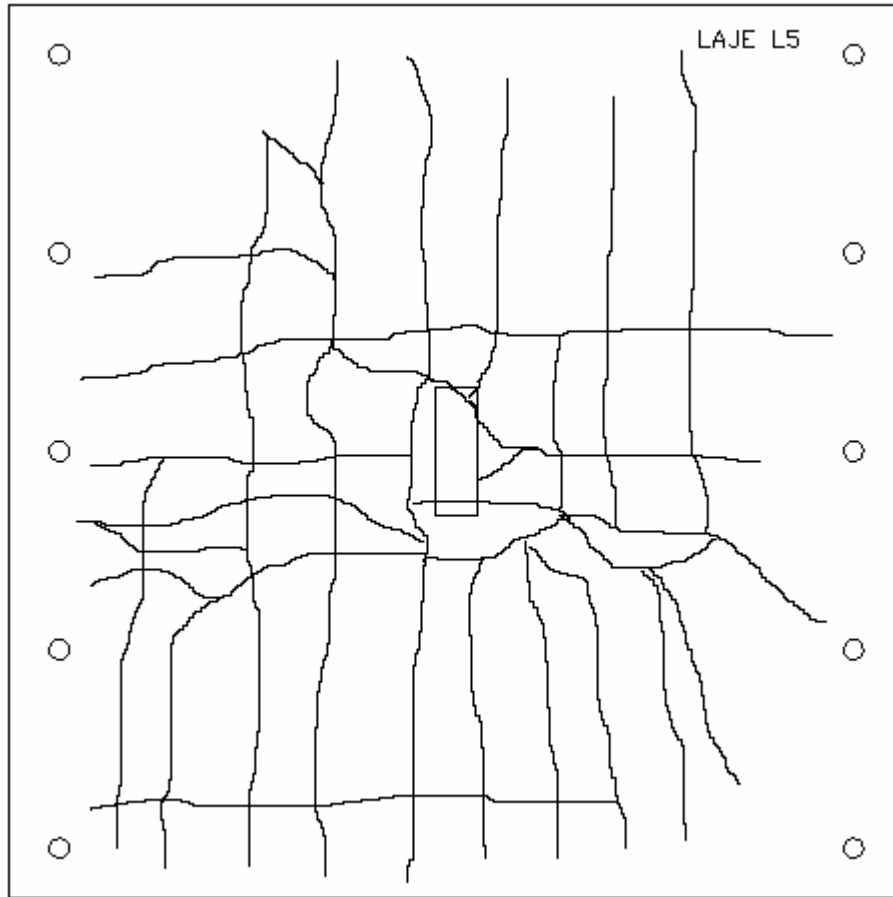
Mapa de fissuração da laje L5
